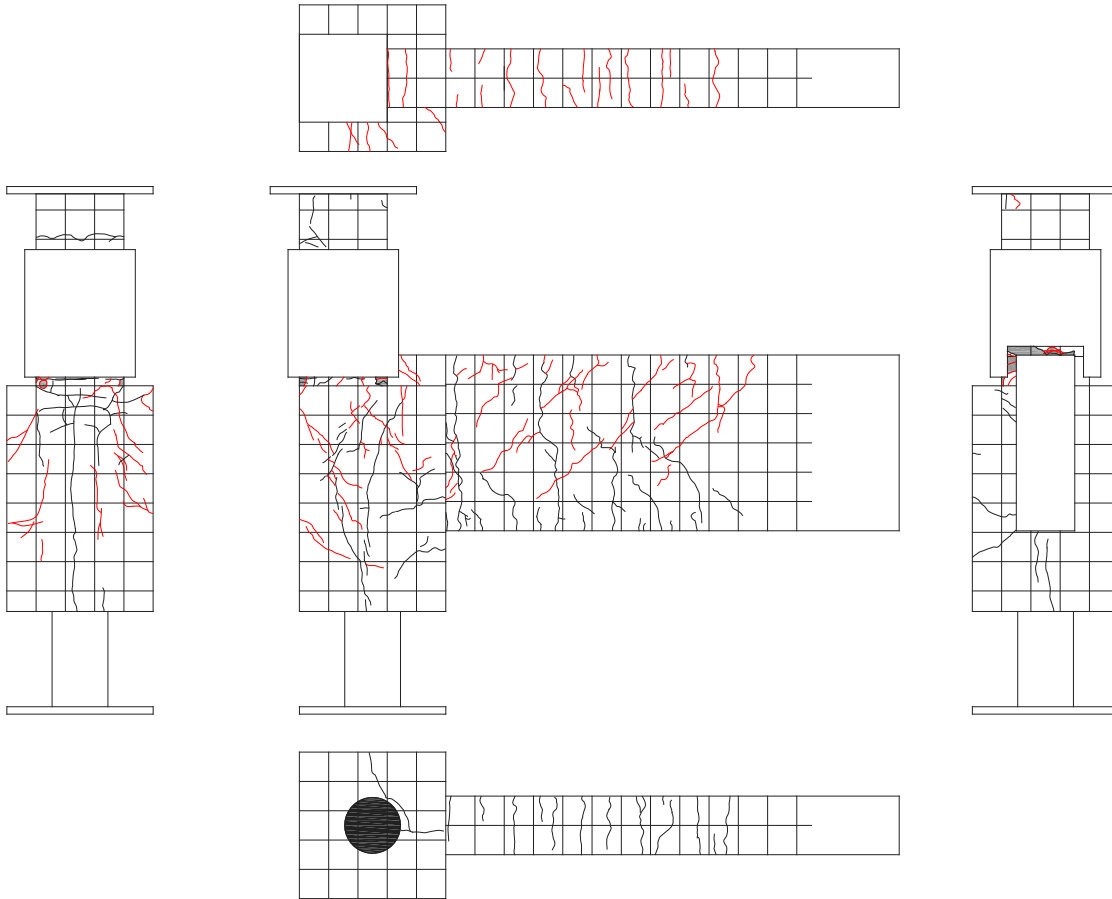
3. 97 試験体 C-2 ひび割れ状況 (6Cycle)
